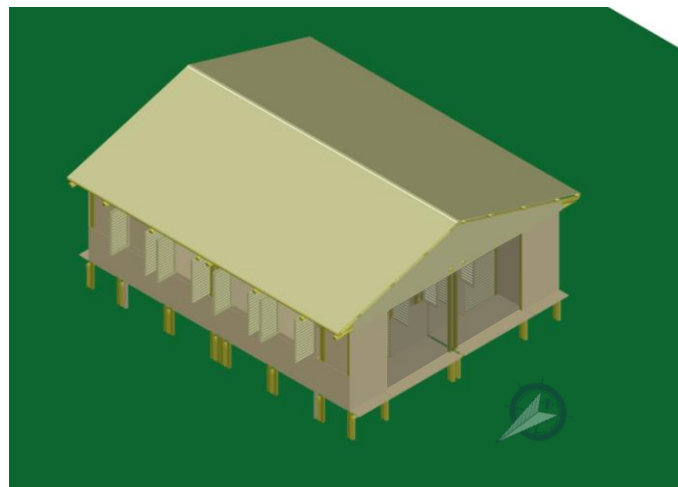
Forma rectangular de la vivienda con fachadas más largas orientadas a sur y norte. Fuente: Elaboración Propia
